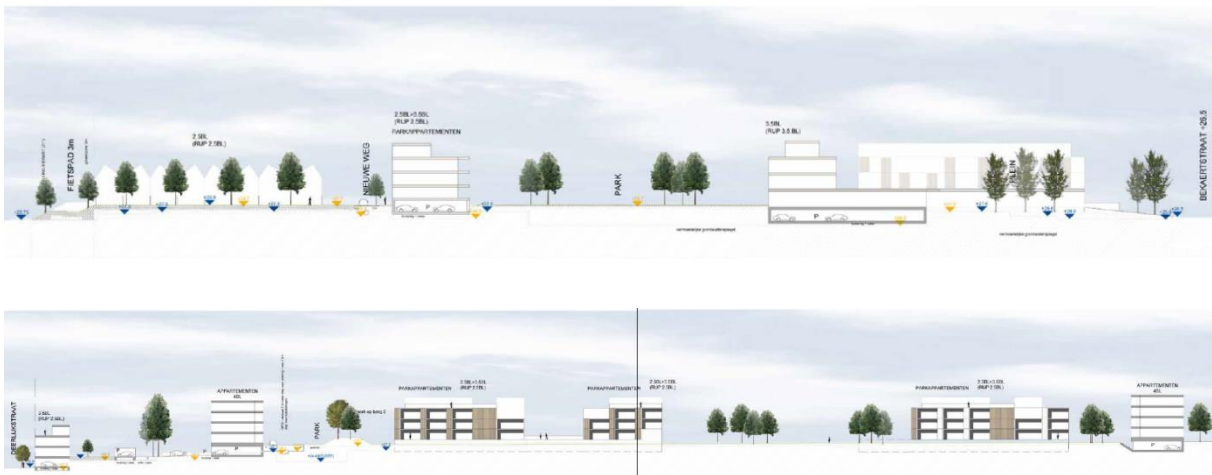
Weergave van de geplande verkaveling (uitsnede door BAAC, oorspronkelijk plan in bijlage)
